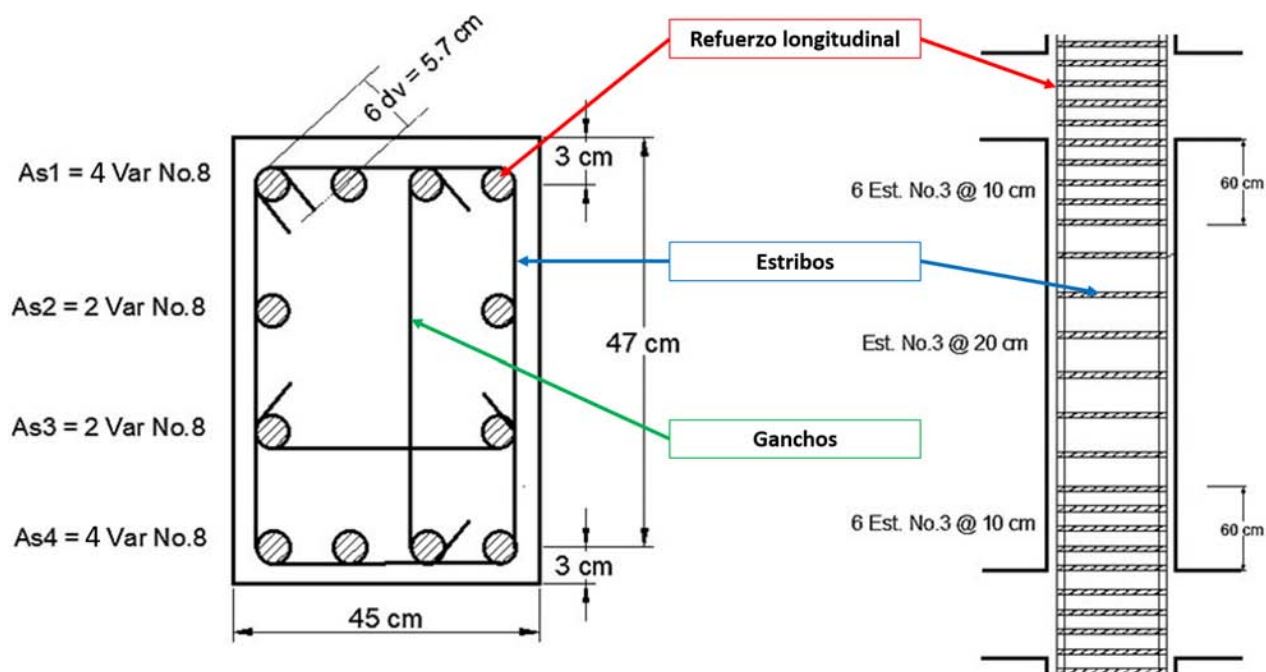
Armado de columna, vista del área transversal y longitudinal de la columna.
